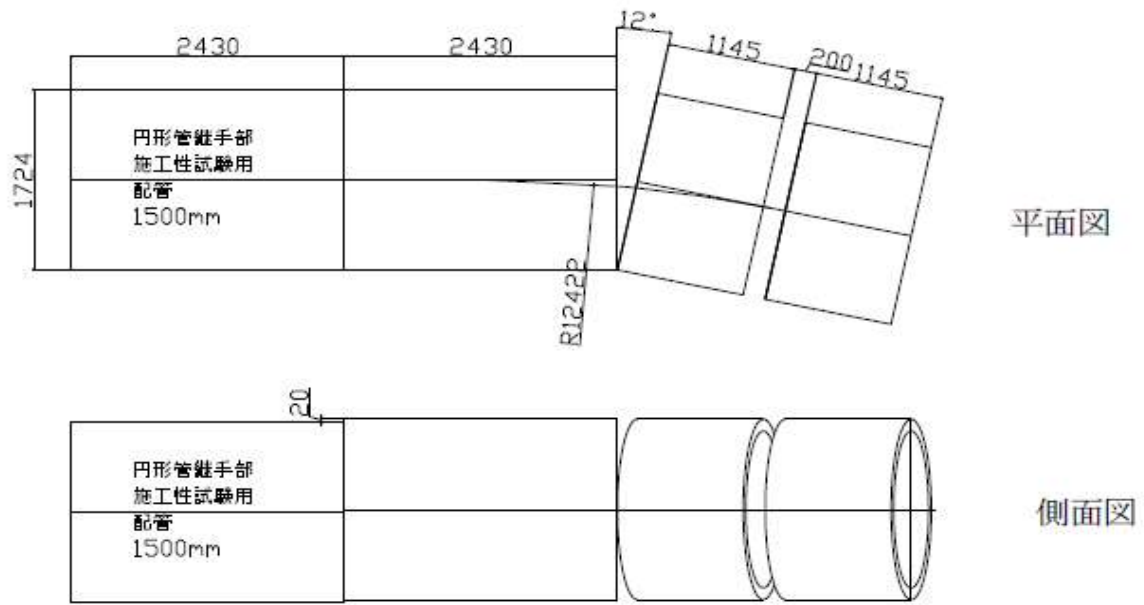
円形管継手部の施工性試験の配管図 (単位 mm)
